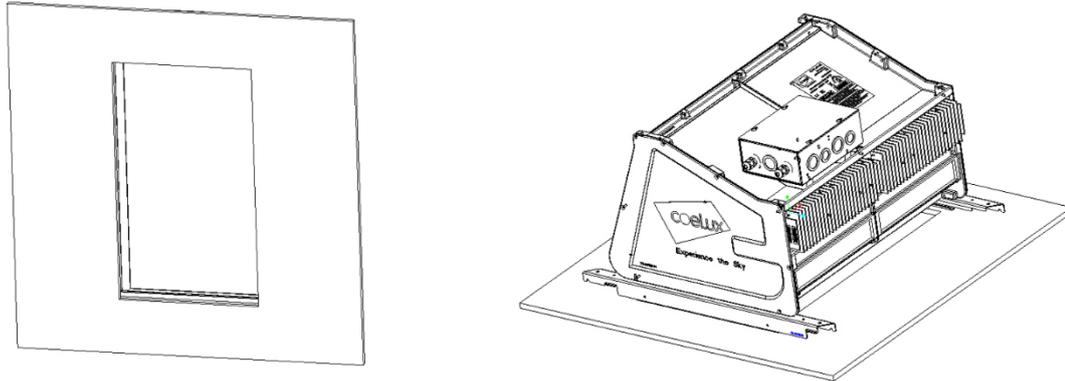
Fixation au faux plafond type plaques en plâtre: passage B.
